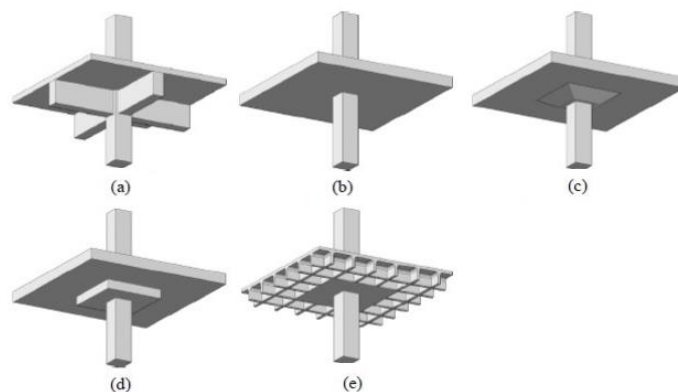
Tipos de lajes: (a) - laje vigada, (b) - laje fungiforme maciça, (c) - laje fungiforme com capitel de espessura variável, (d) - laje com capitel de espessura constante, (e) - laje aligeirada [4].
